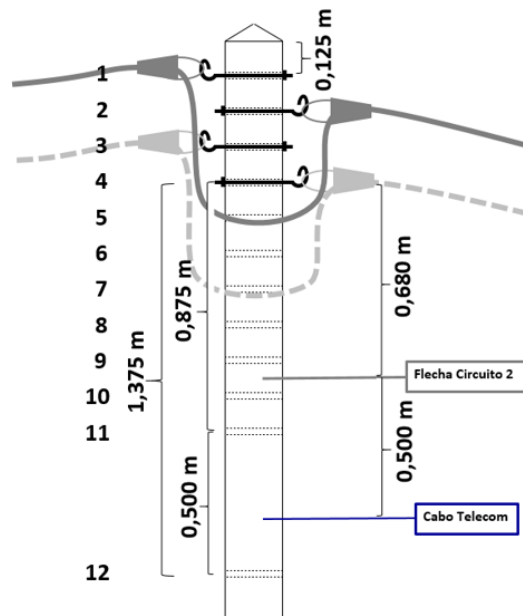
Pormenor da cabeça de apoio de betão, num apoio da rede de BT
